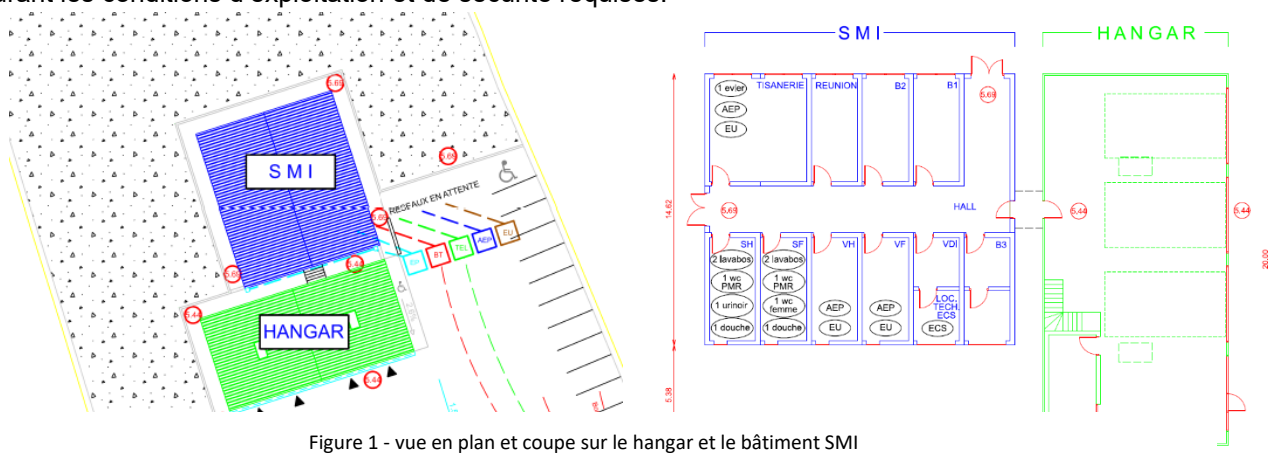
vue en plan et coupe sur le hangar et le bâtiment SMI
